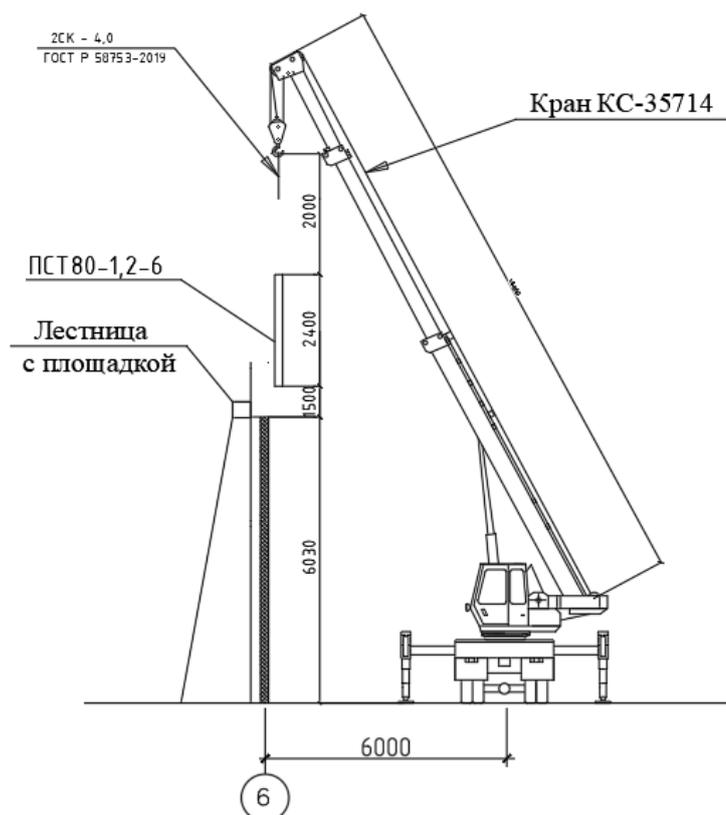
Схема монтажа кровельных панелей» [5]
